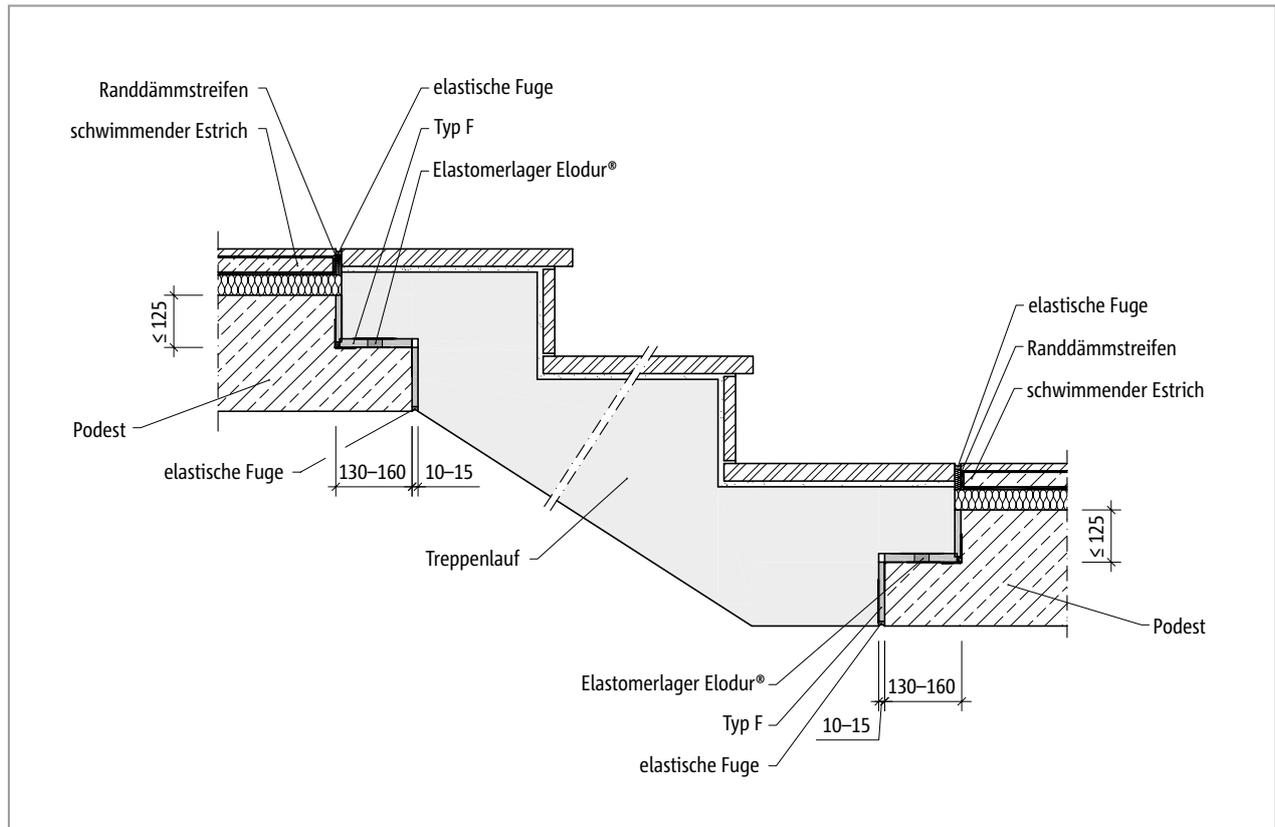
Schöck Tronsole® Typ F: Einbauschnitt
